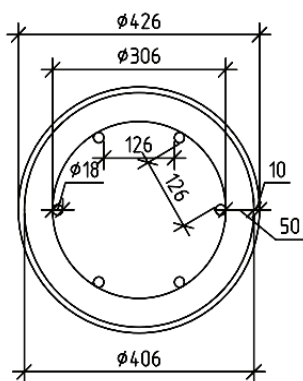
Схема колонны круглого сечения с жестким внешним армированием (вариант 1) – труботетон.
